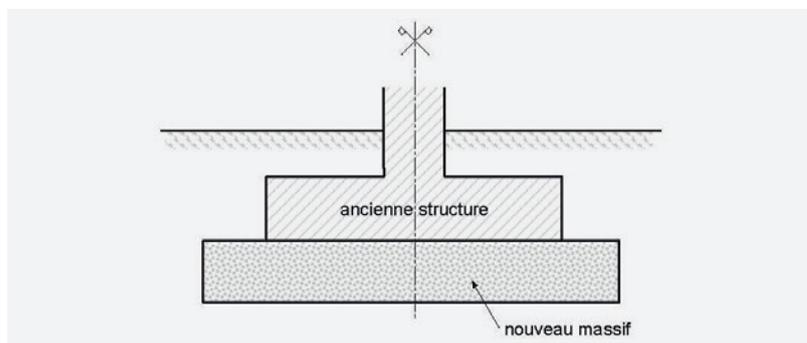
renforcement de fondation à un niveau inférieur au niveau d'origine.
